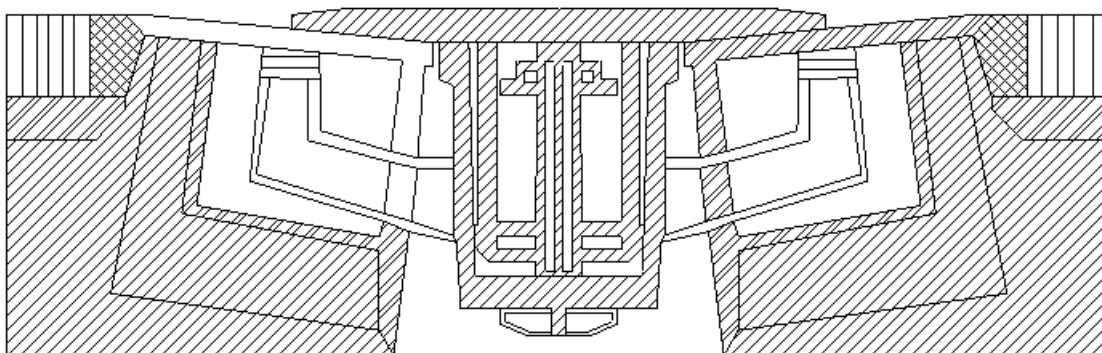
Пример деформационного шва перекрытого типа (Вид конструкции: зазор перекрыт скользящими стальными плитами)
